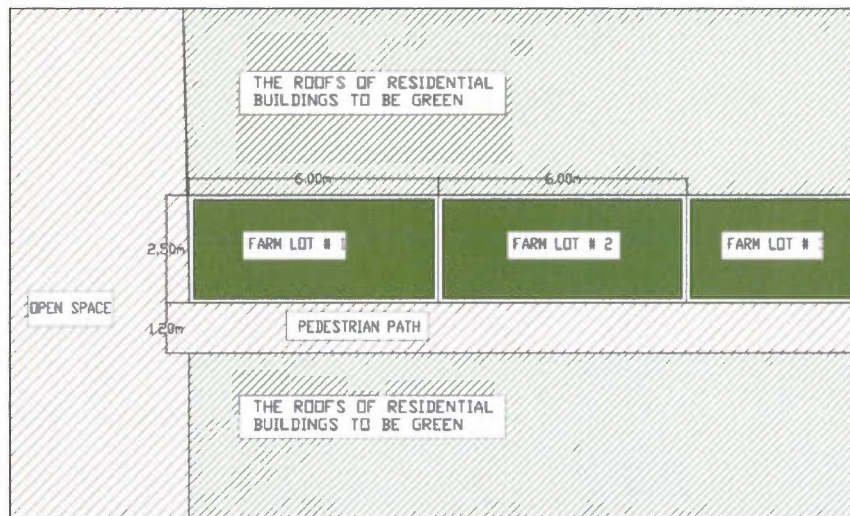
Détail du site plan proposé pour îlot n° 2
